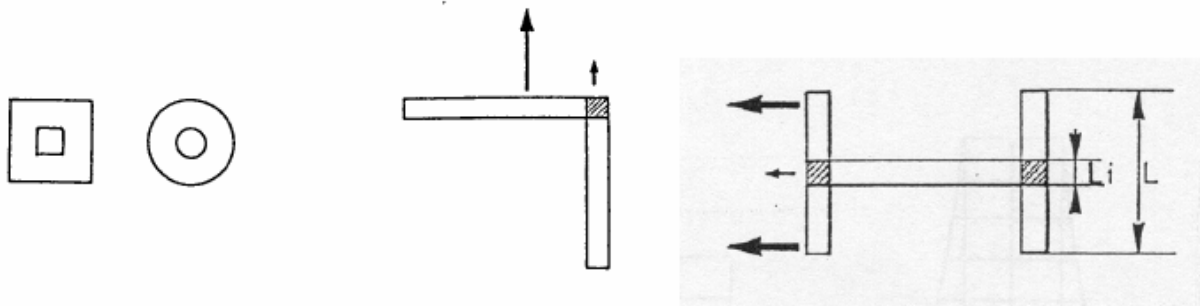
Vues en plan de bâtiments. A gauche : symétriques et compacts en plan. A droite : effets néfastes de l'asymétrie ou du caractère non compact.
